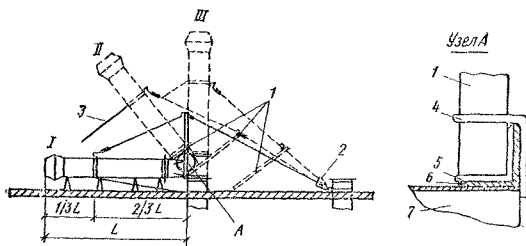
Монтаж вентиляционной шахты с помощью «падающей мачты»
